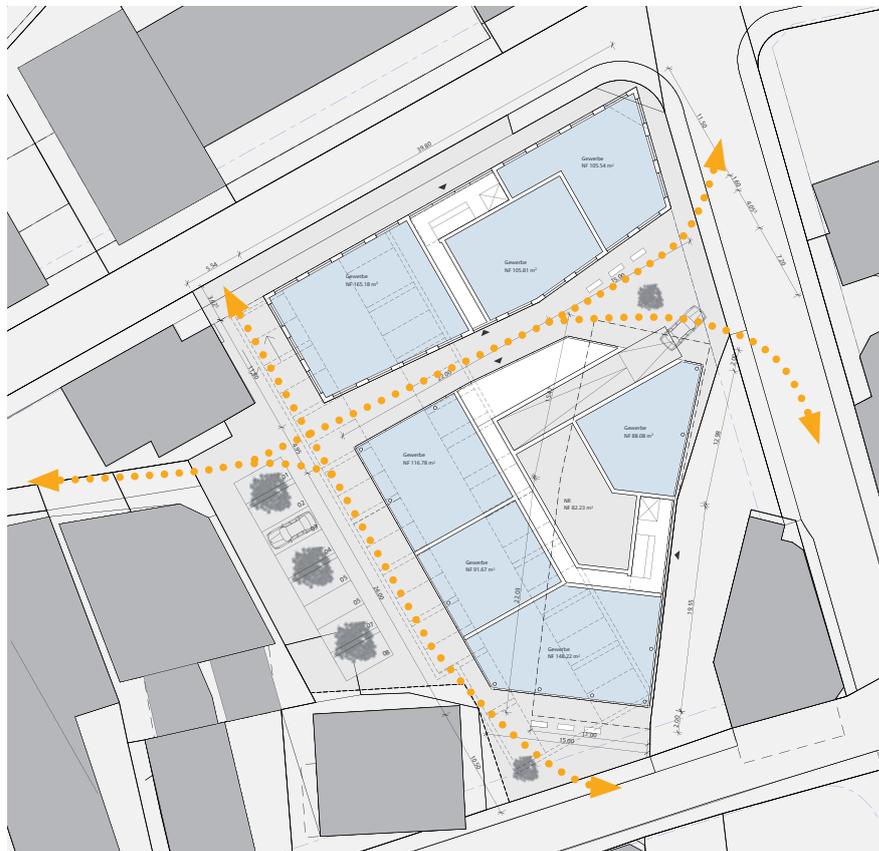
Aussenräume mit Erdgeschoss, Parkierung und Durchwegung
